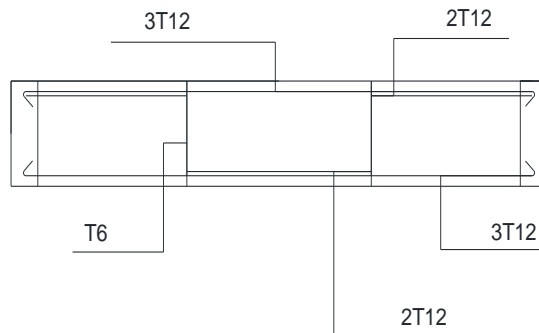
Coupe longitudinale d'une poutre secondaire 20x30cm (plancher au dalles pleines)
